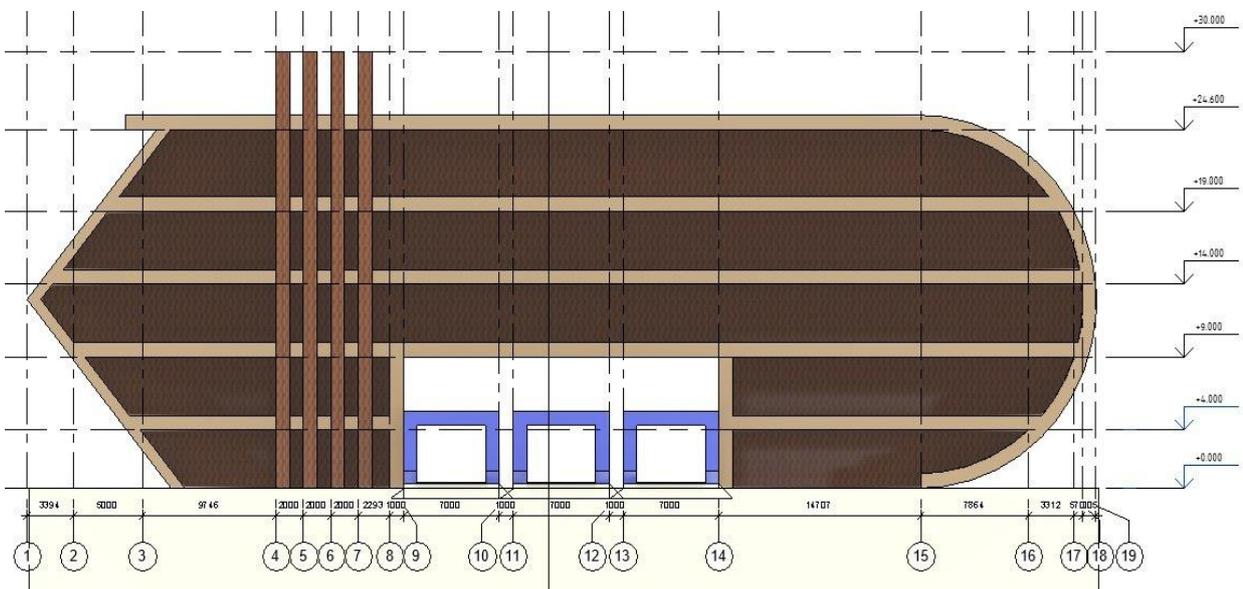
Фасад в осях 1 – 19 по оси А
